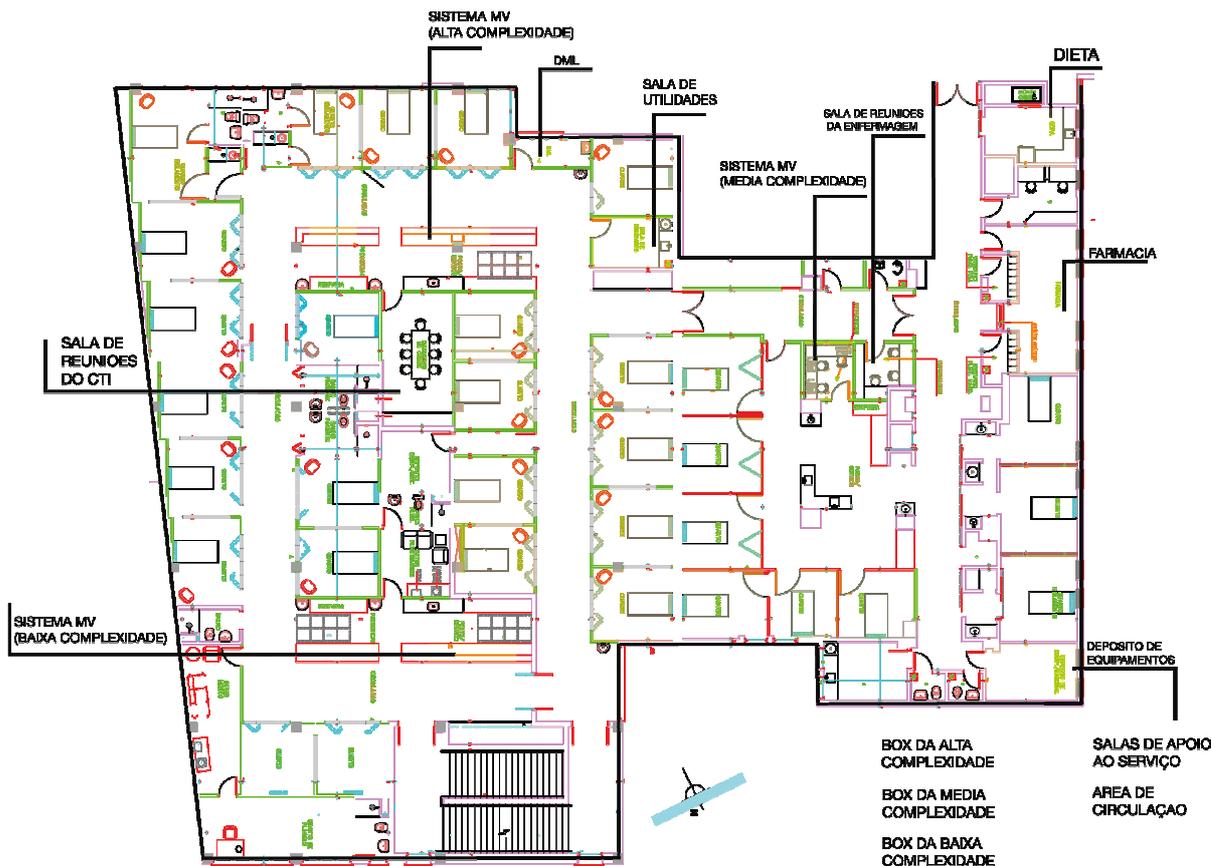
Layout da planta baixa do CTI do Hospital Mãe de Deus
